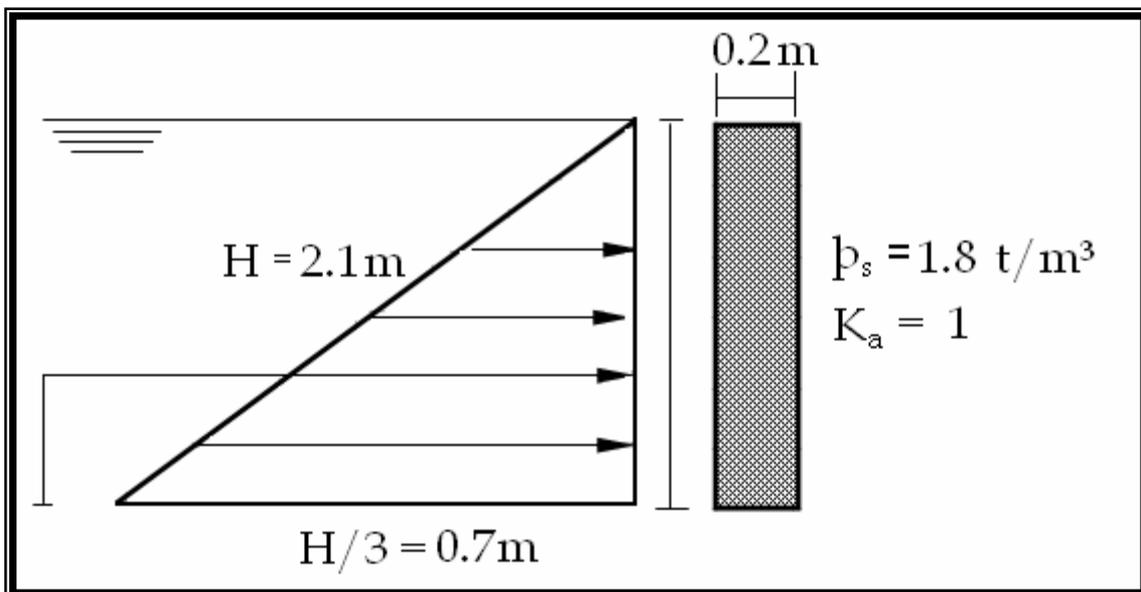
Diseño del muro (Cara exterior) Tanque de Almacenamiento.
